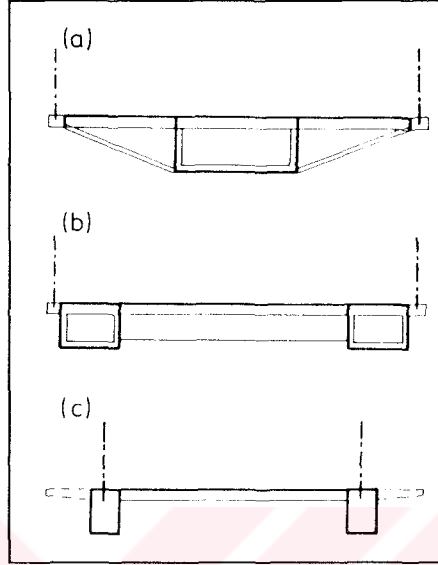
Faro Köprüsünün rijitlik kirişi elemanı.
